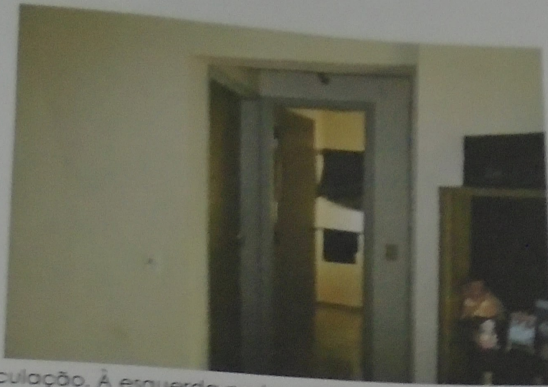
Hall de circulação. À esquerda porta do dormitório, ao fundo porta do banheiro social
